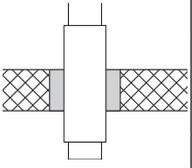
Fixpunkt mit Konsole auf Brettstapeldecke
